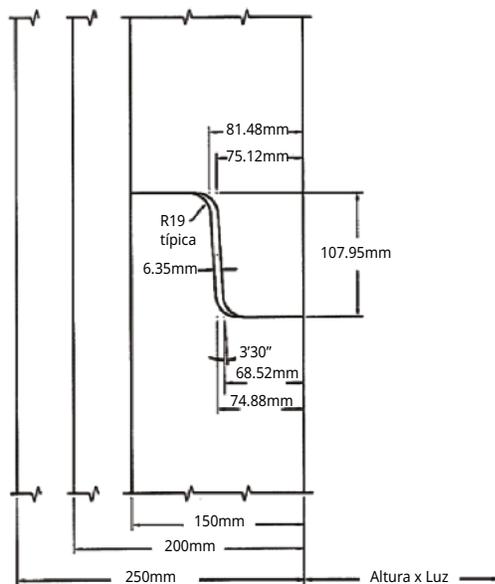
Geometría de la junta de alcantarillas de cuadro
